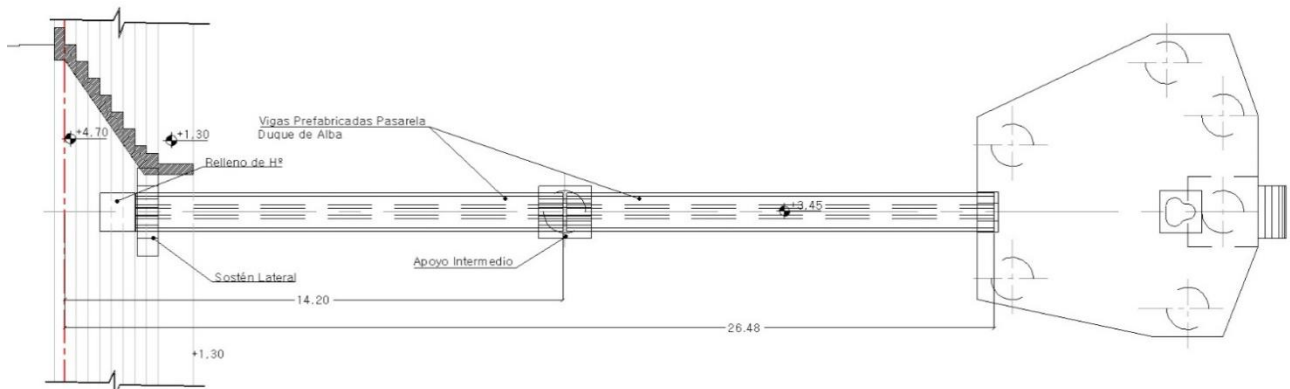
Planta de la pasarela de acceso al Duque Nº 2.
